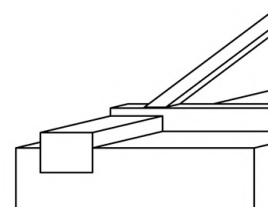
Unión del armazón de la cubierta de madera con el muro en la Ermita de San Isidoro.
